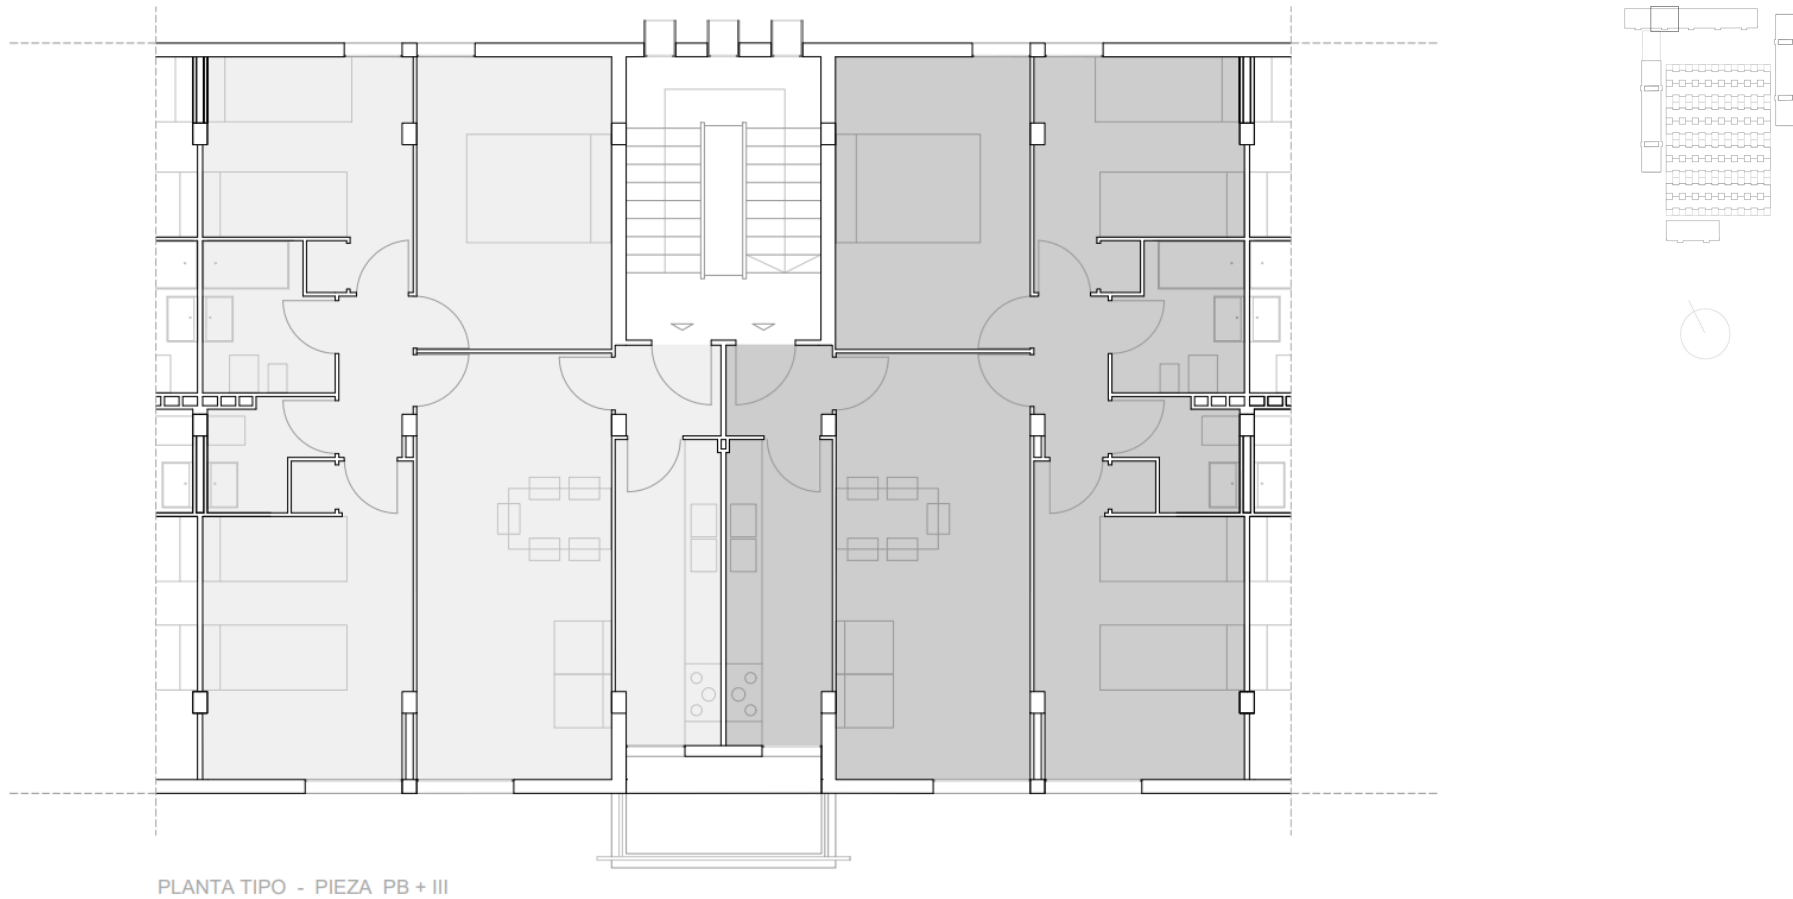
Bloque de viviendas A4-3. Planta tipo. Fuente: *Elaboración propia.
